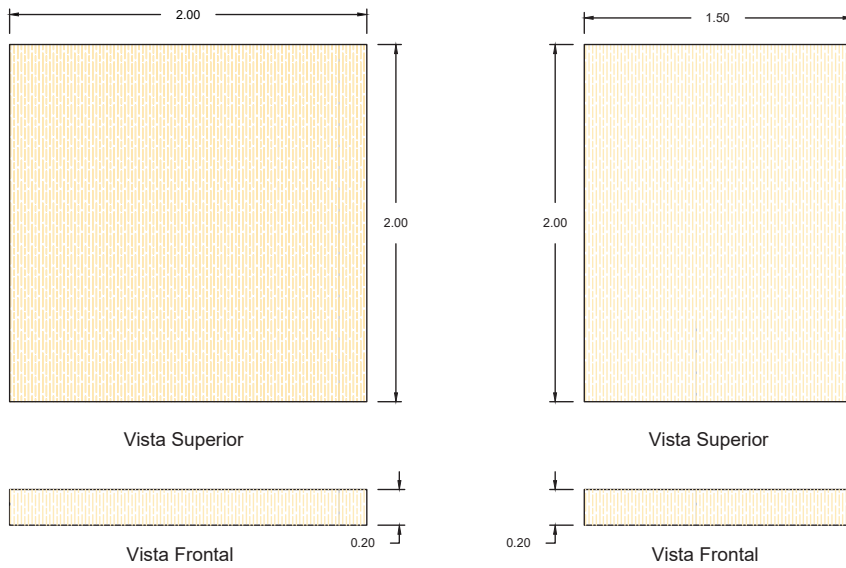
Planimetría Bases. Ilustración: Tanya Briones
